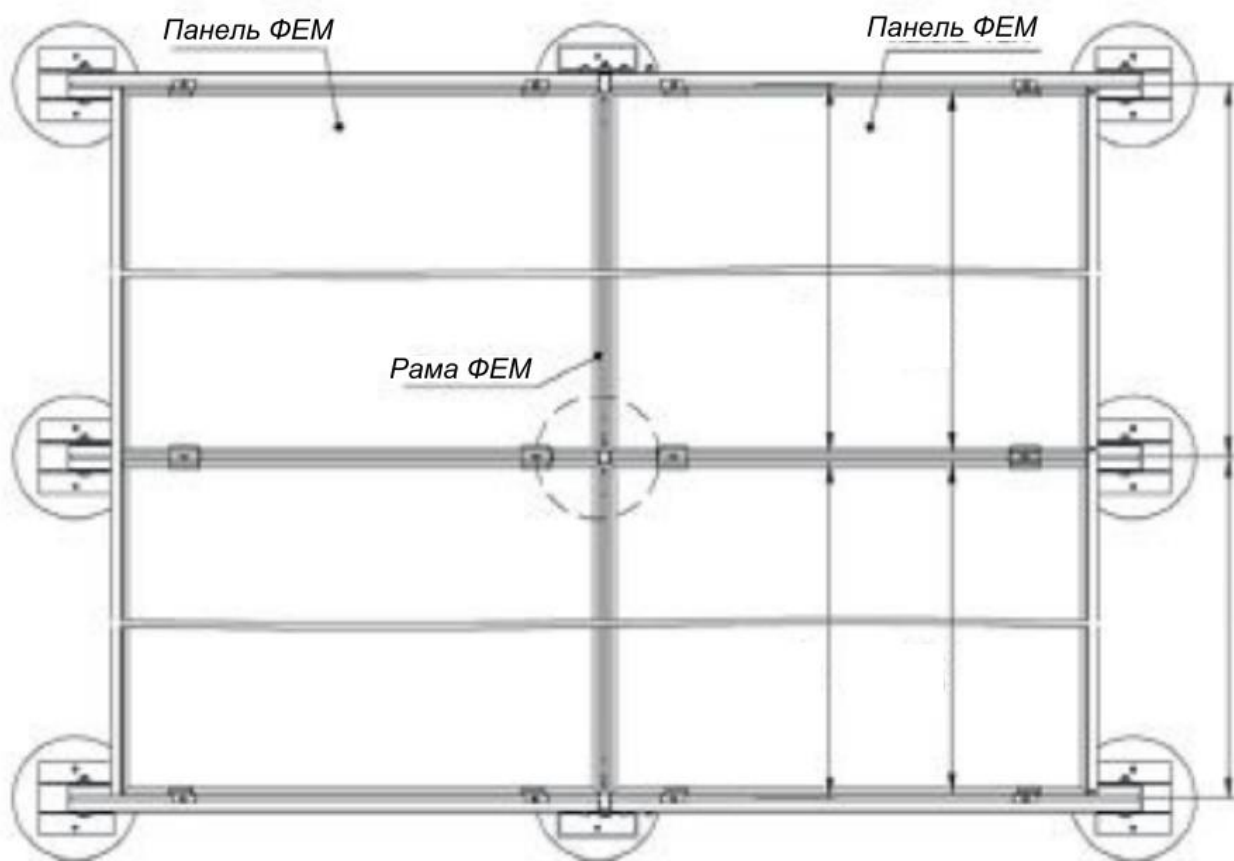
Схема розміщення фотопанелей на кріпленні
